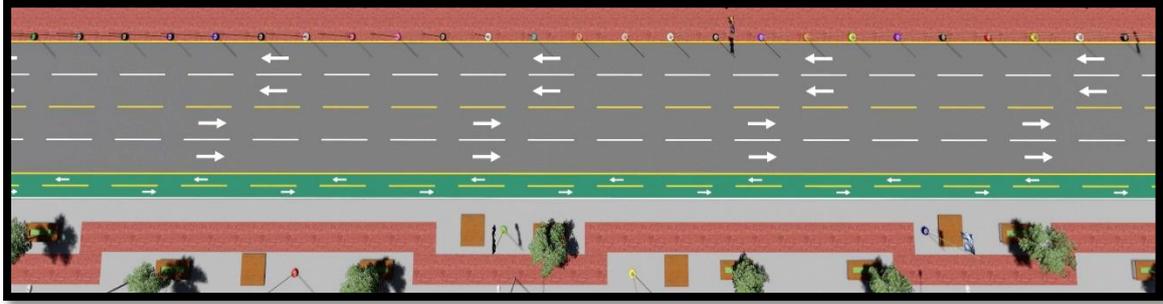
Vista en planta de la Av. F. Elaboración propia.
